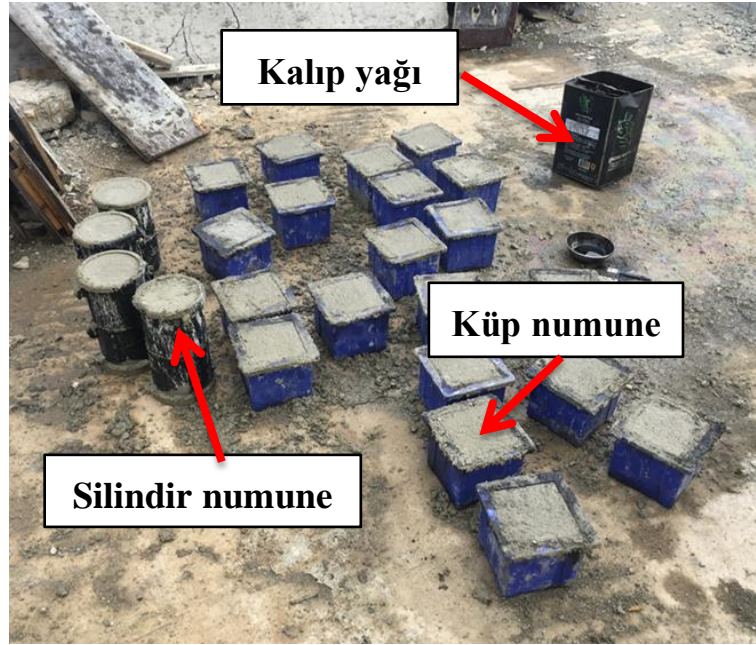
Beton döküm işleri ve betonarme numunelere vibratör uygulanması.
